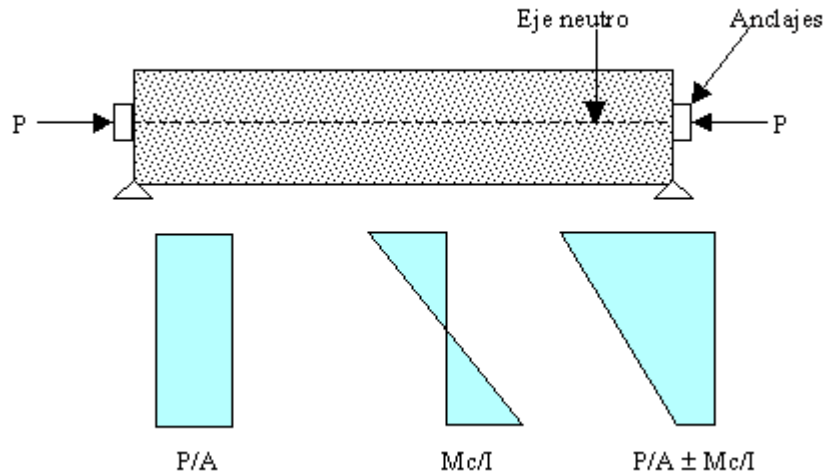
Distribución de esfuerzos a través de una sección de concreto presforzado concéntricamente
